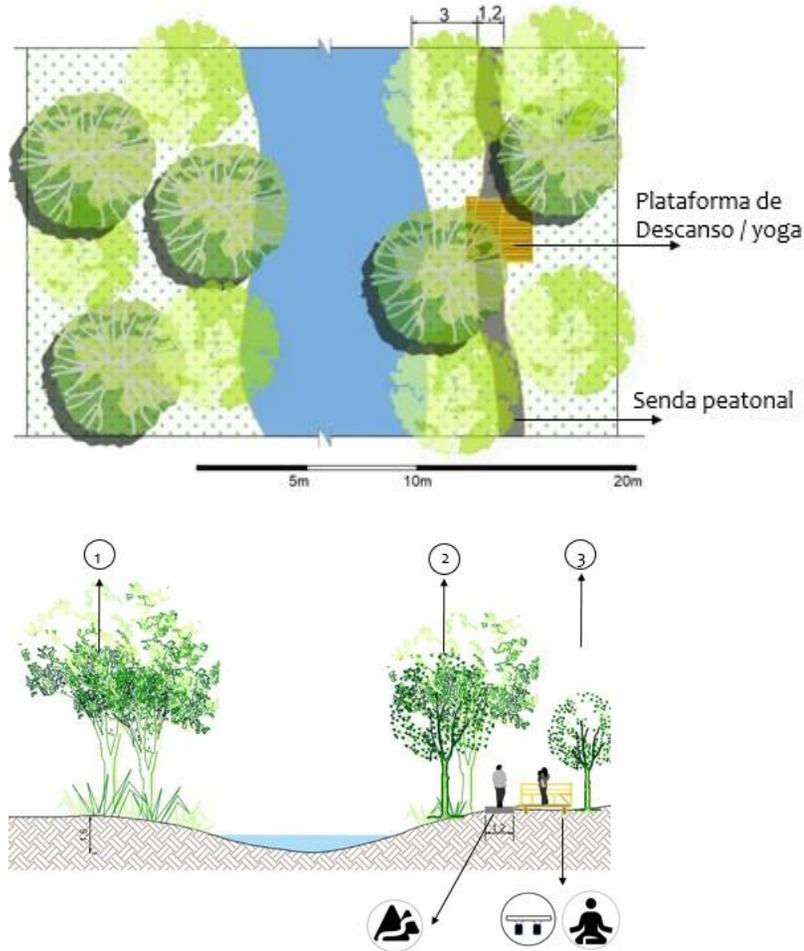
Planta arquitectónica y corte transversal senda por el tipo 1. Fuente: Elaboración propia.
